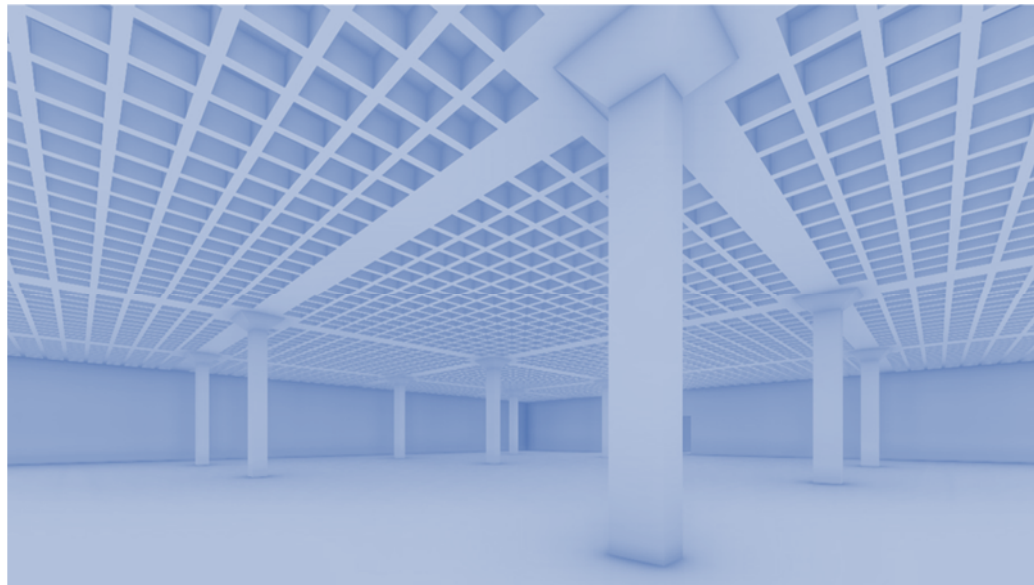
Vista 3D de la estructura del estacionamiento. - Fuente: Elaboración propia.
